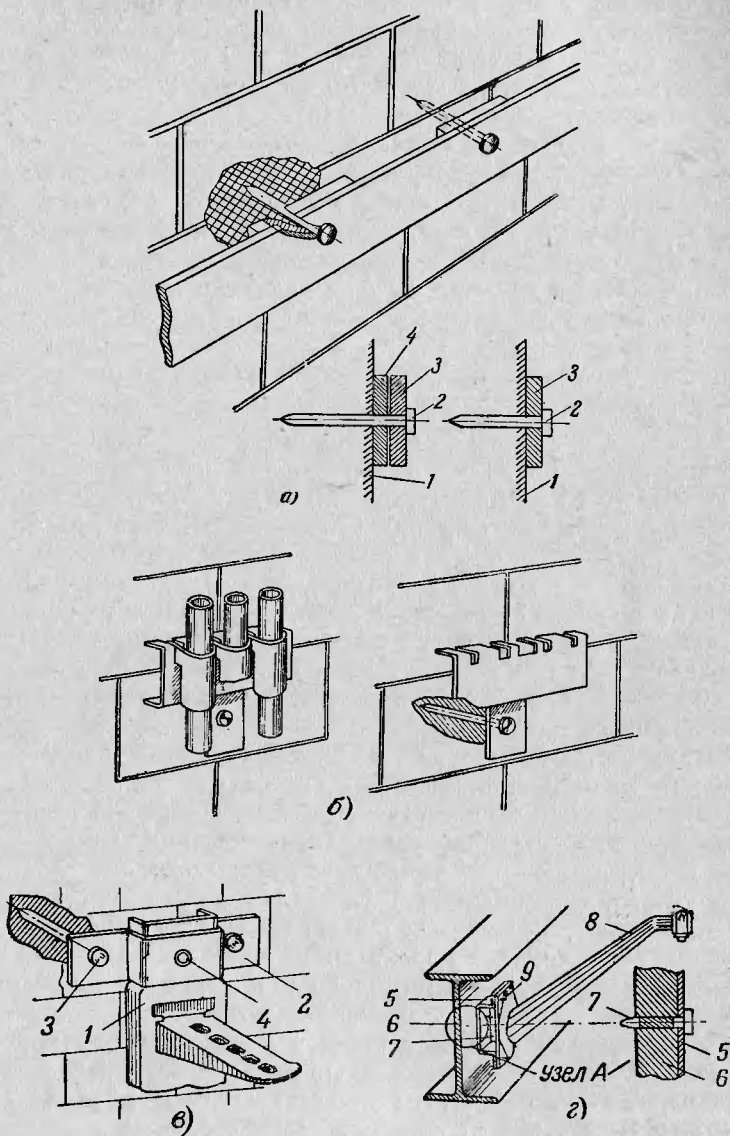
Несъемное крепление дюбелями-гвоздями деталей и конструкций.
